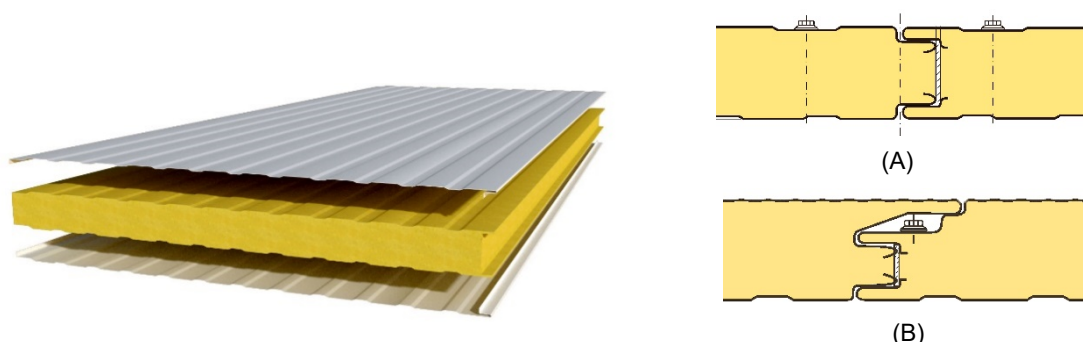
Panel sándwich para fachada con chapas exteriores metálicas onduladas y núcleo aislante de poliuretano expandido densidad media 40 kg/m<sup>3</sup> (izquierda). Tipos de unión (A) con tornillería vista. (B) con tornillería oculta (derecha).
